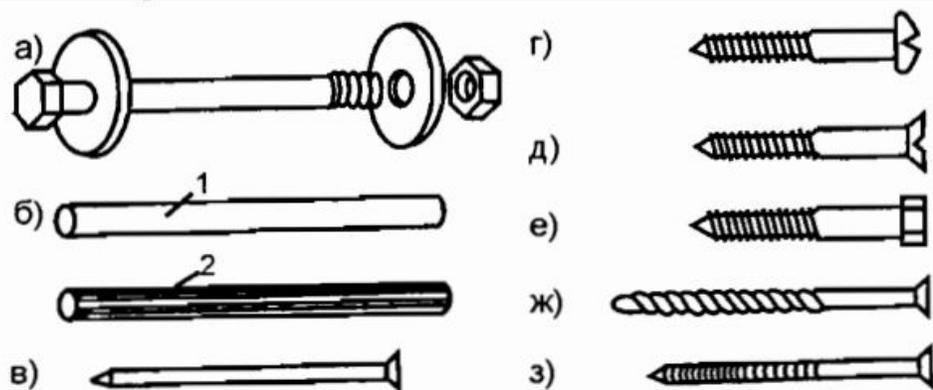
Основные виды цилиндрических нагелей: а - болт с гайкой и круглыми (могут быть также квадратными) шайбами; б - цилиндрический нагель из стали (1), из твердых пород древесины или стеклопластика (2); в - гвоздь; г - шуруп с полузакругленной головкой; е - глухарь; ж, з - особые виды гвоздей с профильной поверхностью
